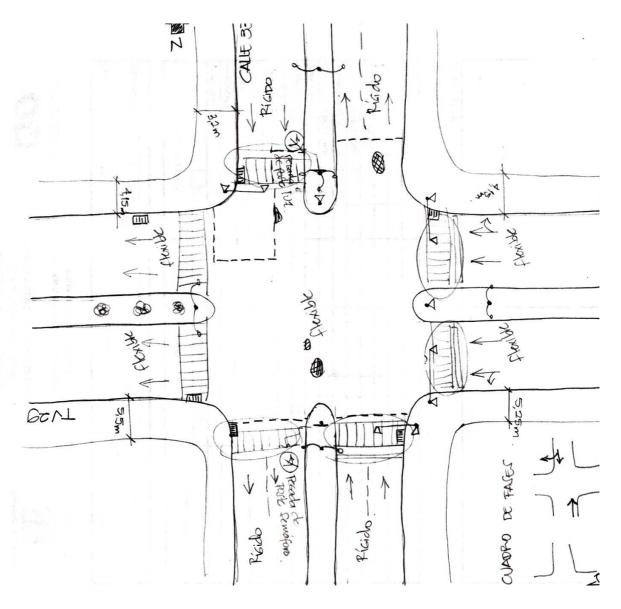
Intersección transversal 29 con calle 33A, la cual posee andenes y el pavimento en buen estado. La intersección no está demarcada.
